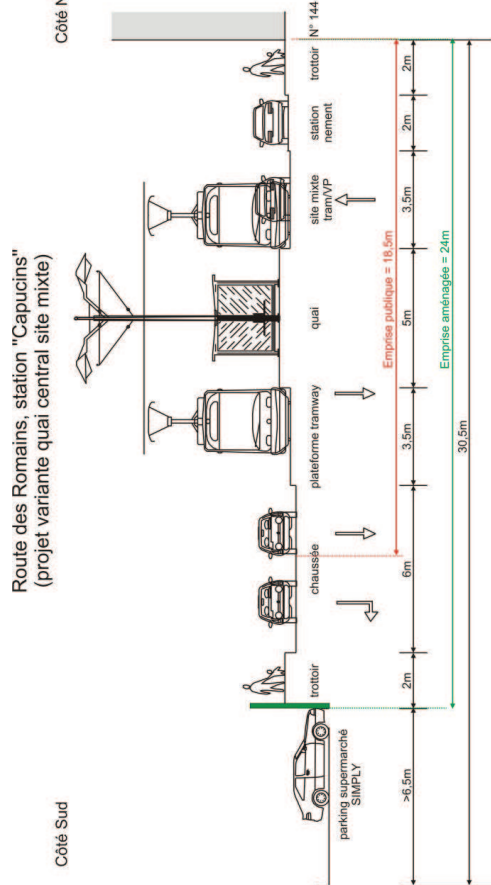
Variante site mixte - coupe 35 (route des Romains) station "Capucins"
